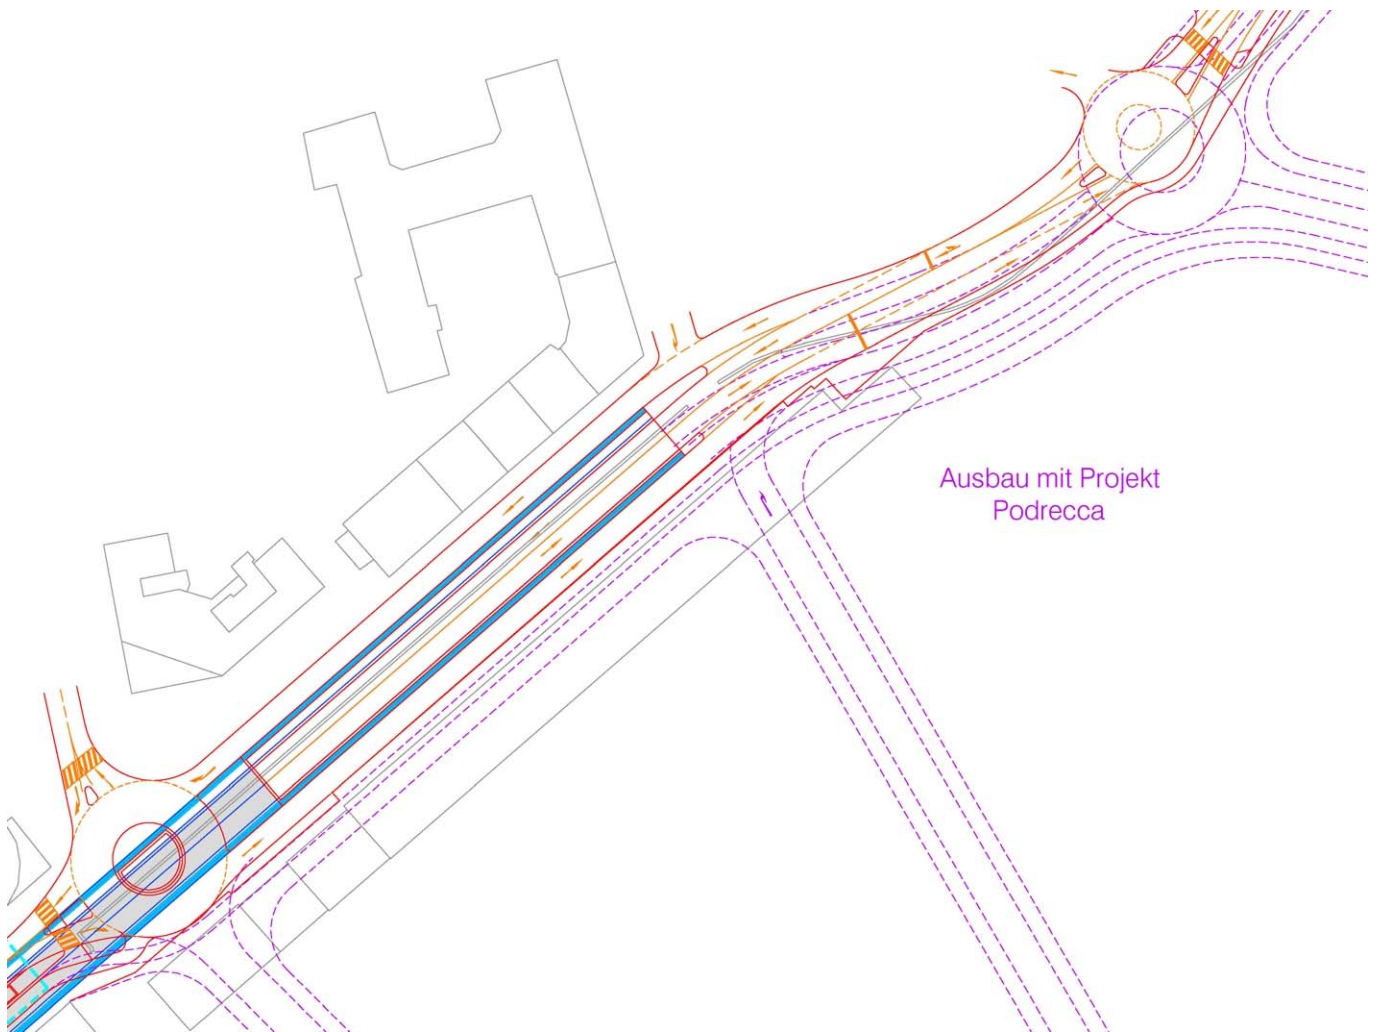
Funktionsplan Verkehr Tunnel – Rittner Straße
